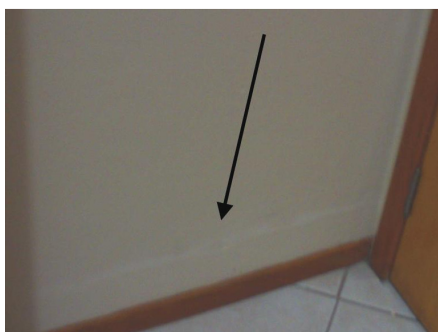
Fissura horizontal próxima ao rodapé.
